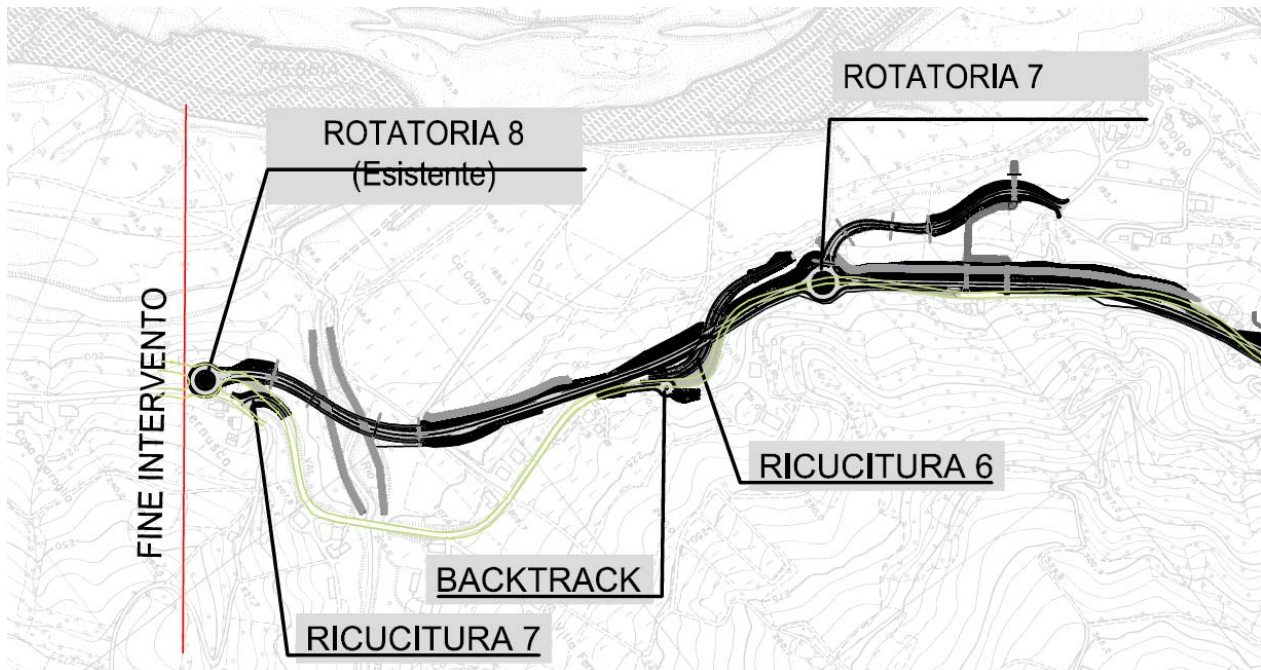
Stralcio planimetrico dell'asse 8. Il tracciato dell'attuale asse della SS.45 è in verde.
